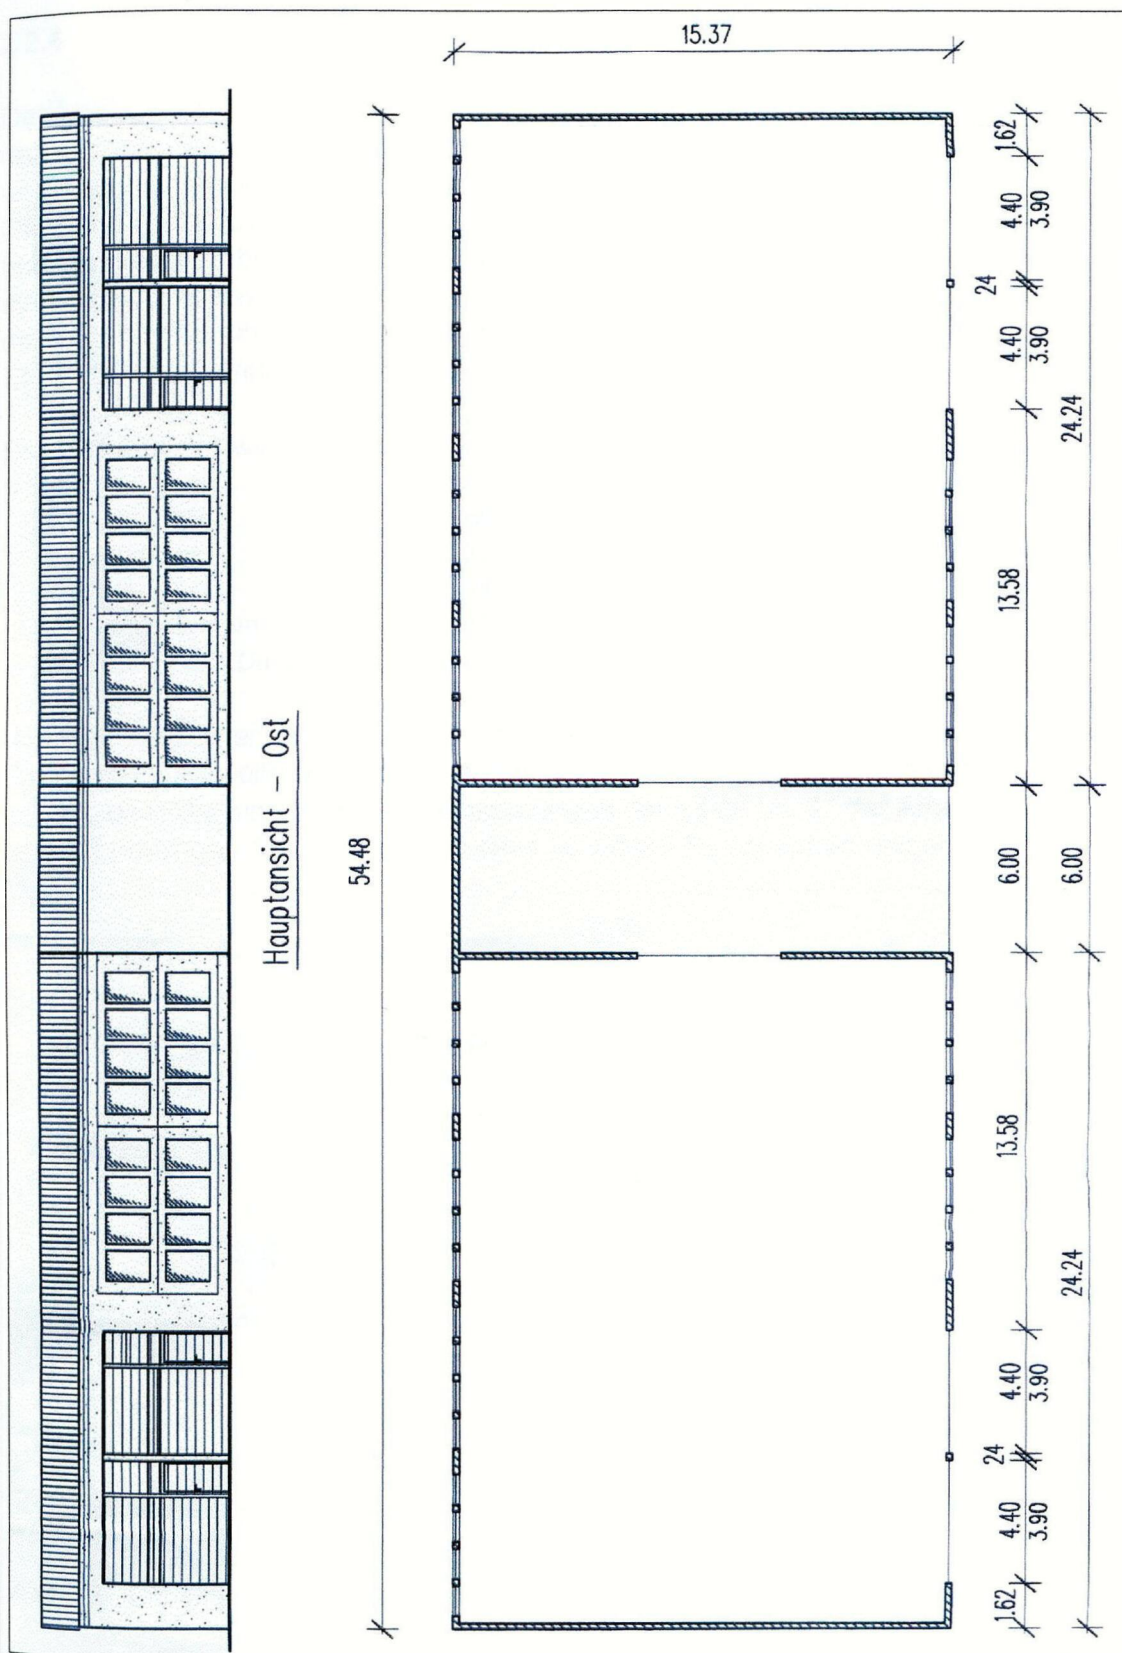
Ansicht und Grundriss der geplanten Maschinen- und Lagerhalle für den Straßen und Tiefbaubetrieb Eichelbaum & Keil GbR (Entwurf: Udo Rank, Ergänzung: RIK)
